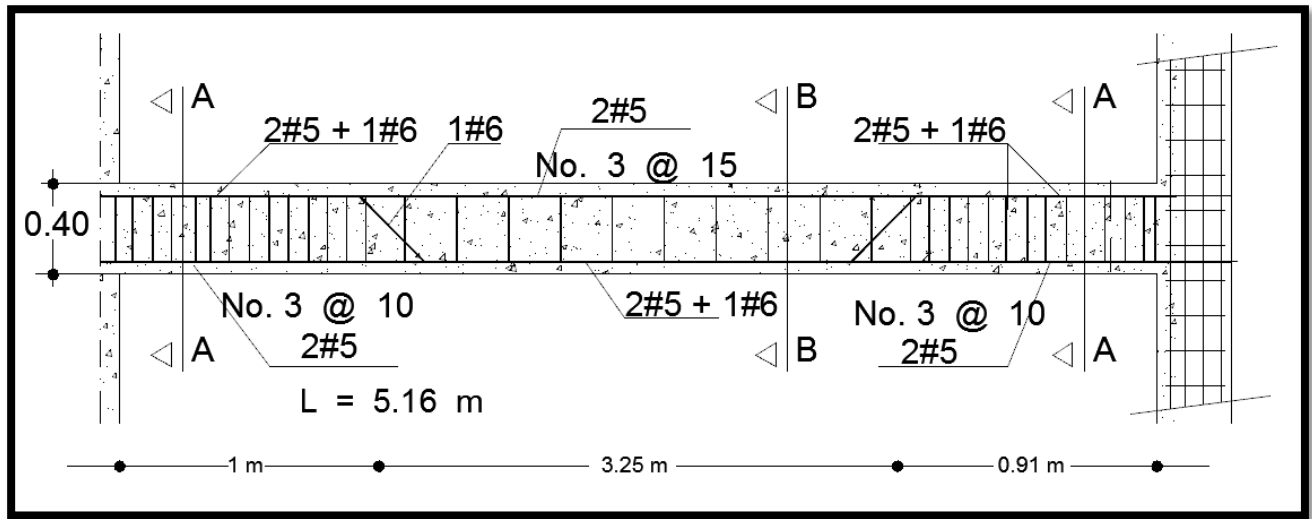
viga E4 del pórtico b1-b3, cuerpo 2.
